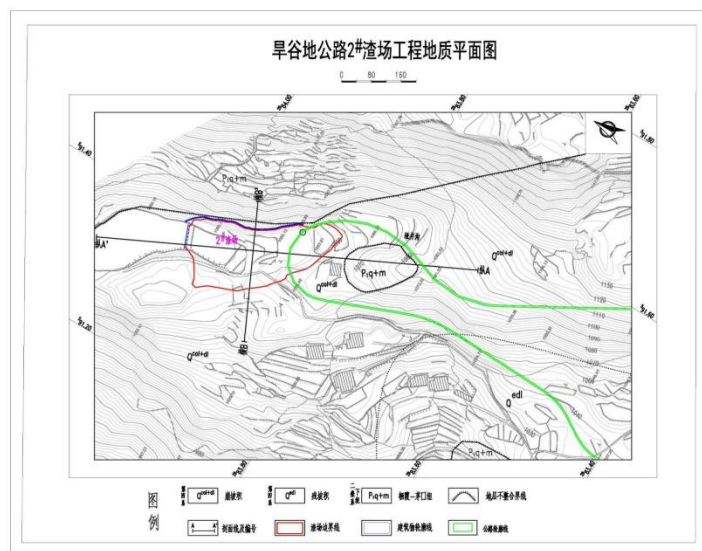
旱谷地公路 2#渣场工程地质平面图
